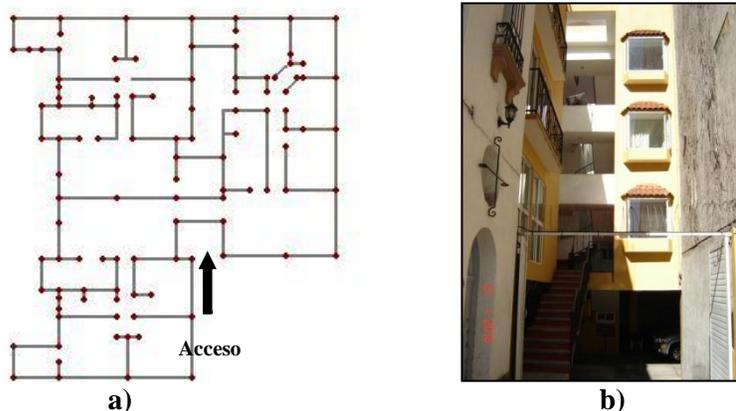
a) Vista en planta primer nivel, b) Fachada principal
